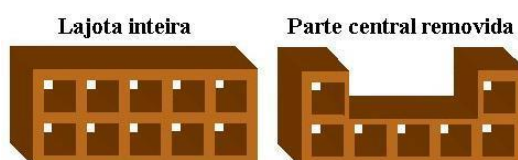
Preparo da lajota para confecção da cinta de concreto.
